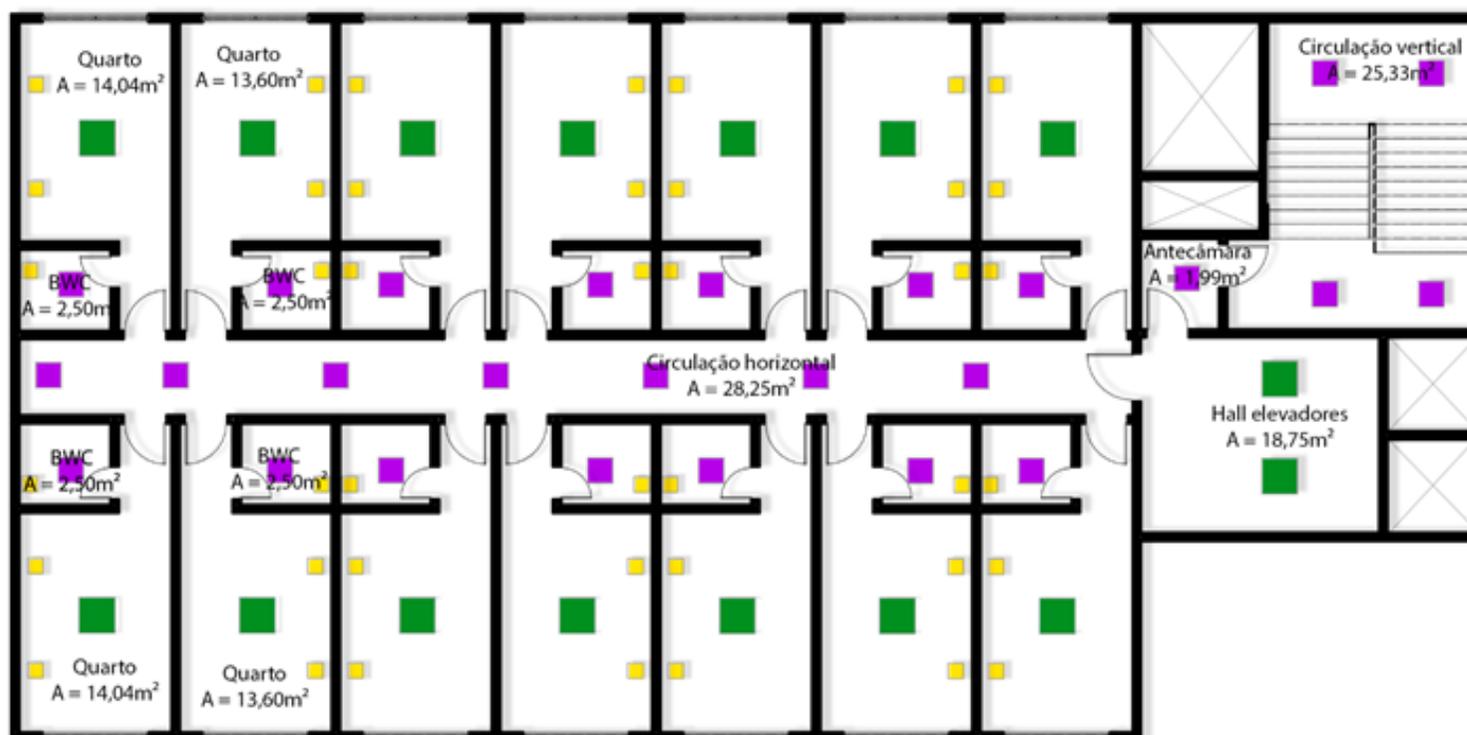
Projeto de iluminação artificial – primeiro pavimento (térreo)
